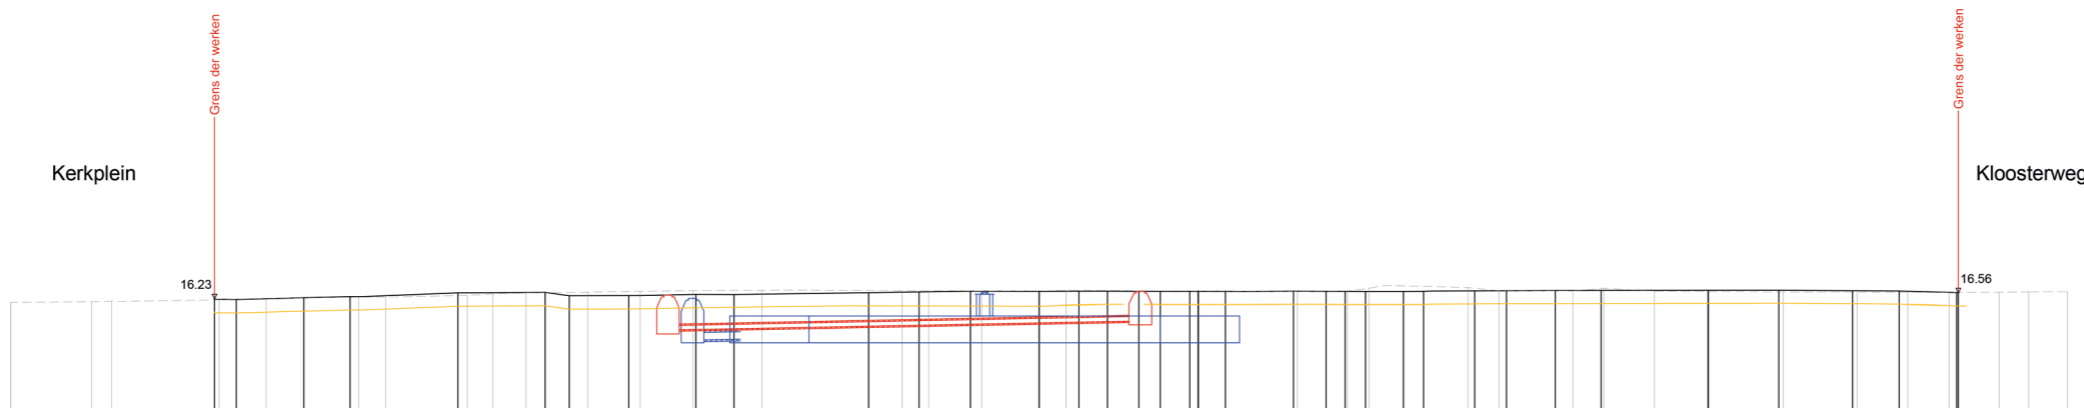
Plan van het geplande grondverzet (rioleringen zijn niet mee opgenomen). (Bron: D+A Consult)
